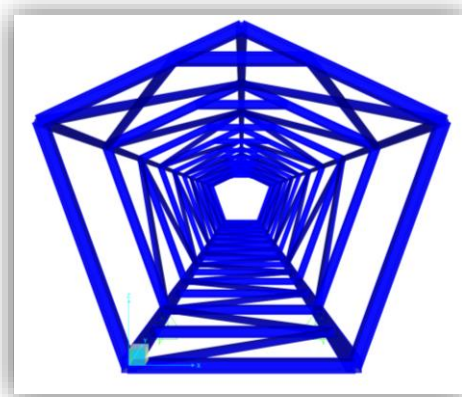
Vista Sección Transversal o Vista Peatón Estructura Central 1.
